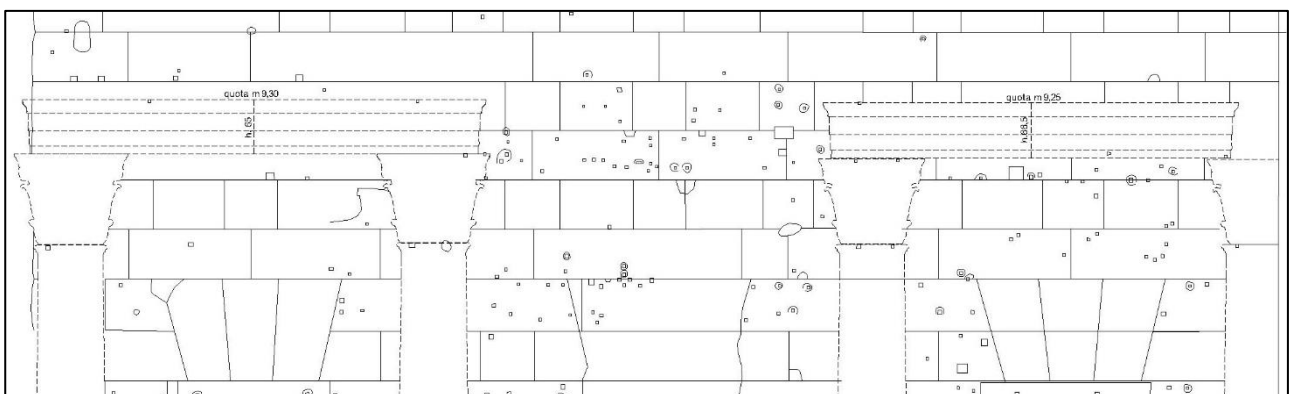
Rielaborazione del rilievo di Bauer del muro di fondo del portico sud, con ricomposizione ipotetica degli architravi
